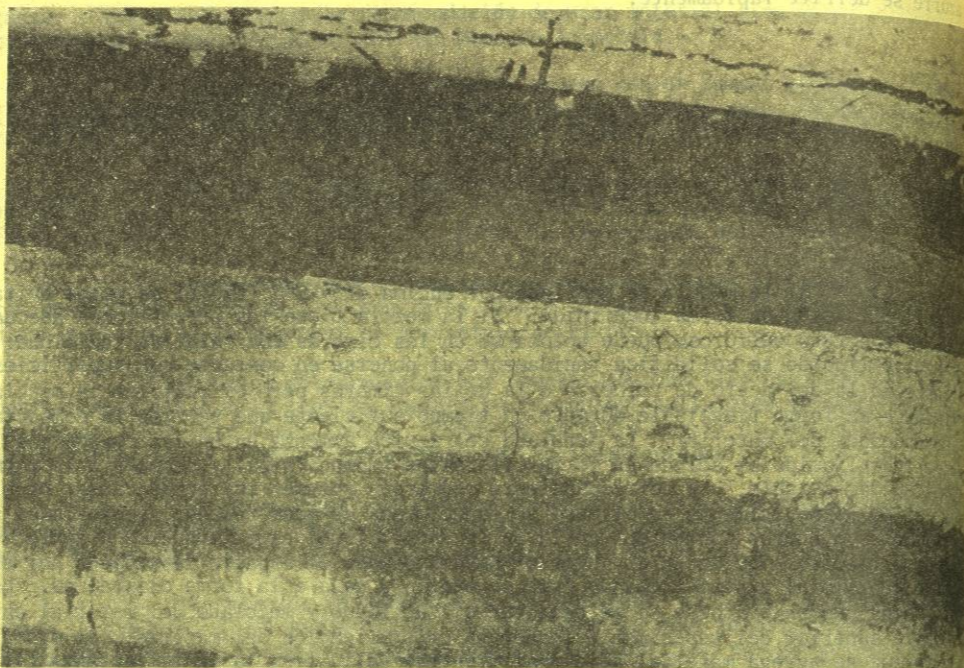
Grieta Vertical por Contracción Térmica
